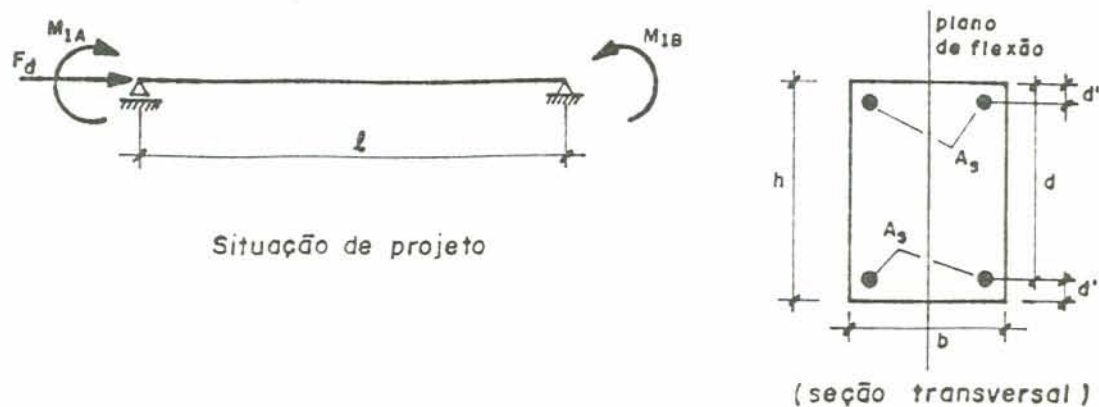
Situação de projeto e seção transversal tipo do pilar.
